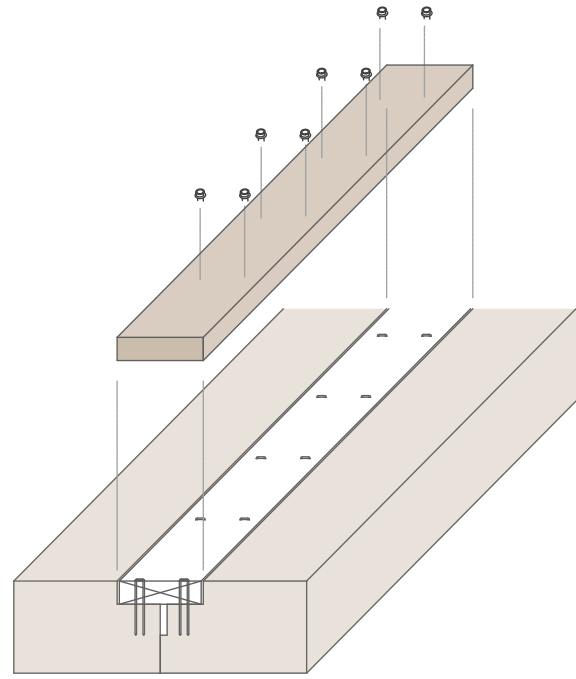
Detail Verbindung der Brettsperrholzelemente
